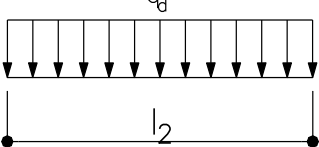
Sơ đồ truyền tải lên dầm khung
